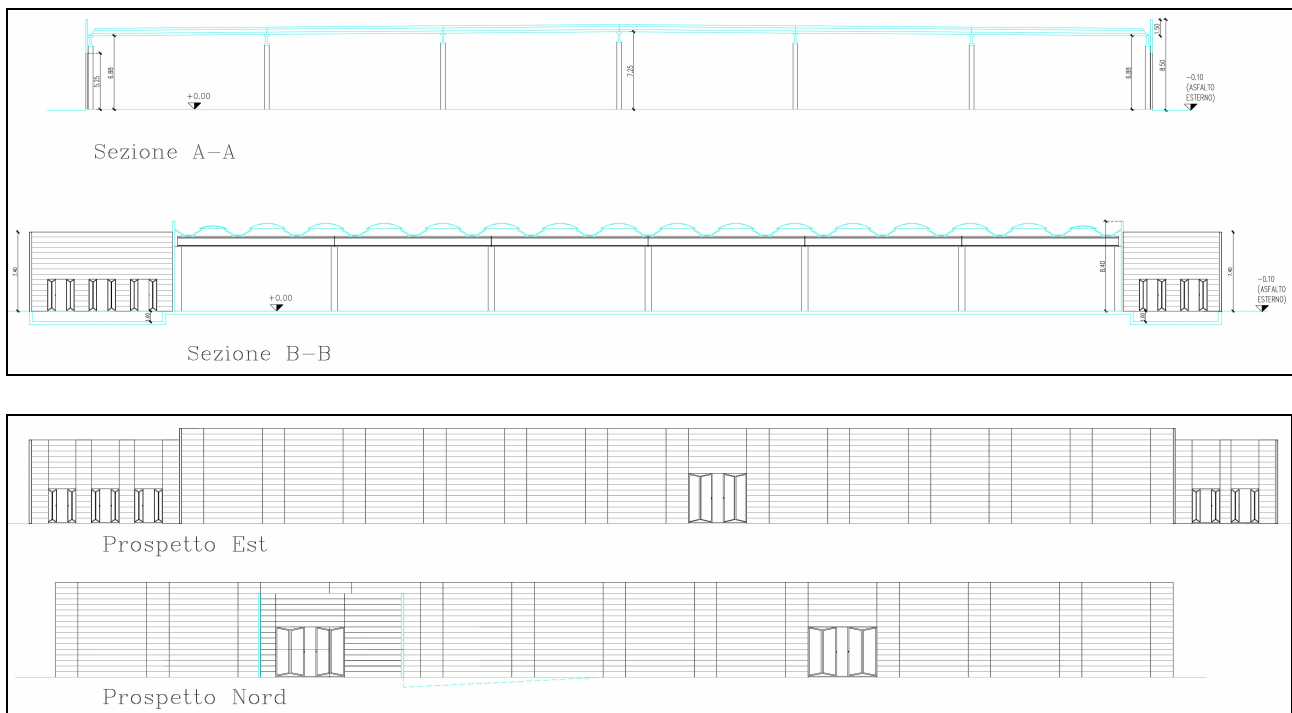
Planimetria di progetto, pianta, prospetti e sezioni
